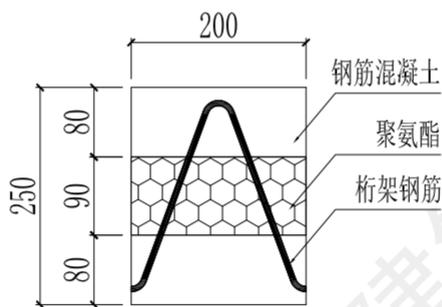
(a) 钢筋线性横向穿越无肋保温层 90mm 承重墙体典型单元
